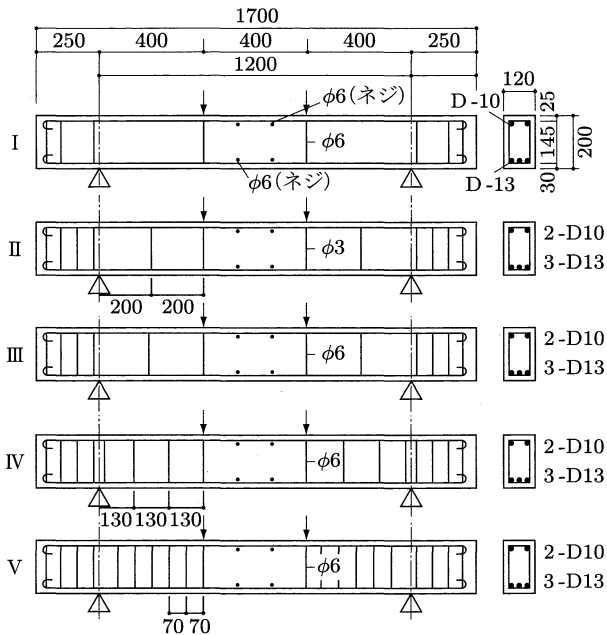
試験体の断面、スパンおよび配筋図 (単位: mm)
